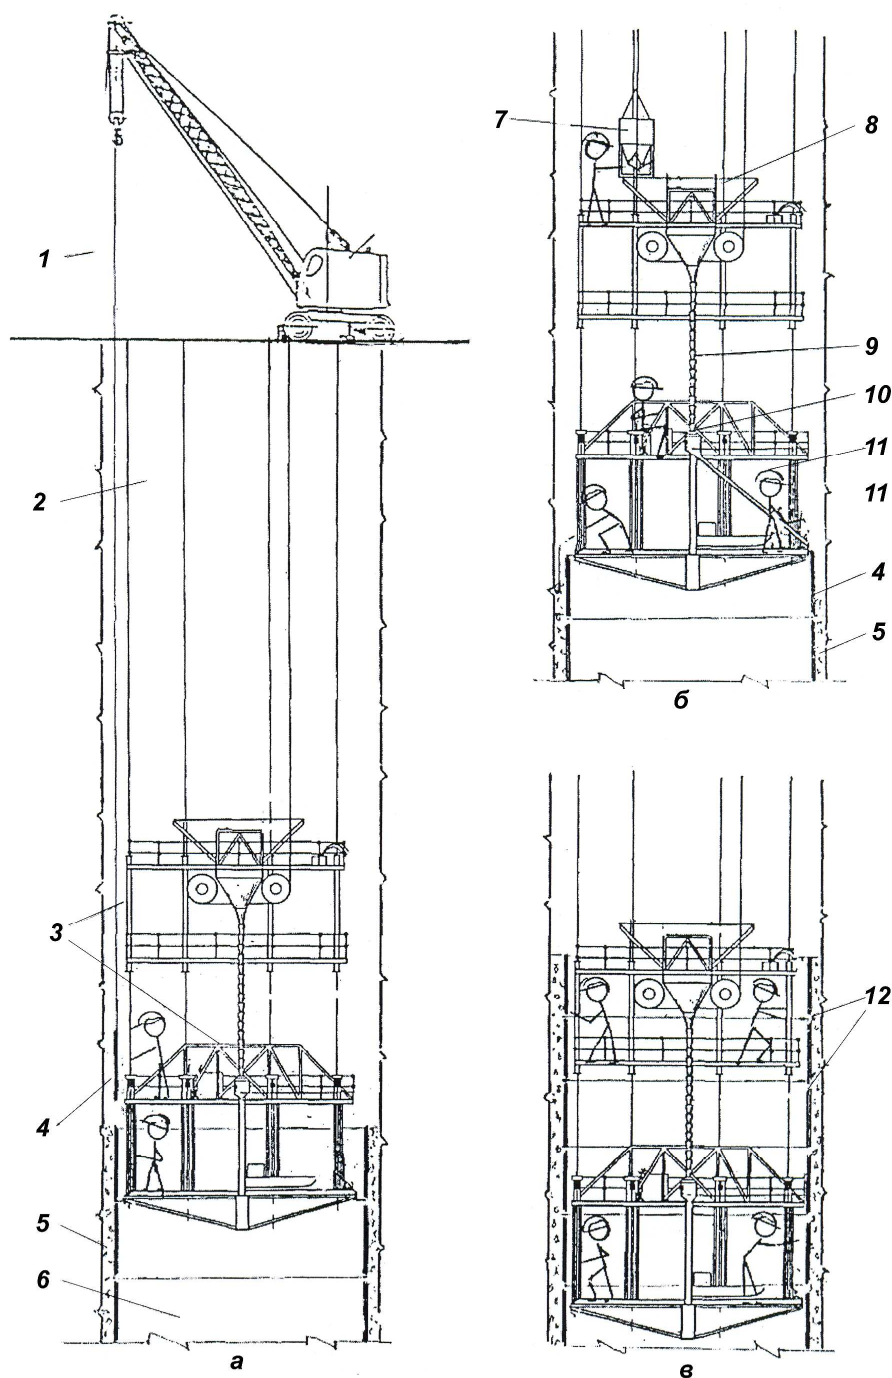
Типовая технологическая схема выполнения облицовочных работ с использованием армированных шлаколитых панелей шахтного ствола прямоугольной формы:
